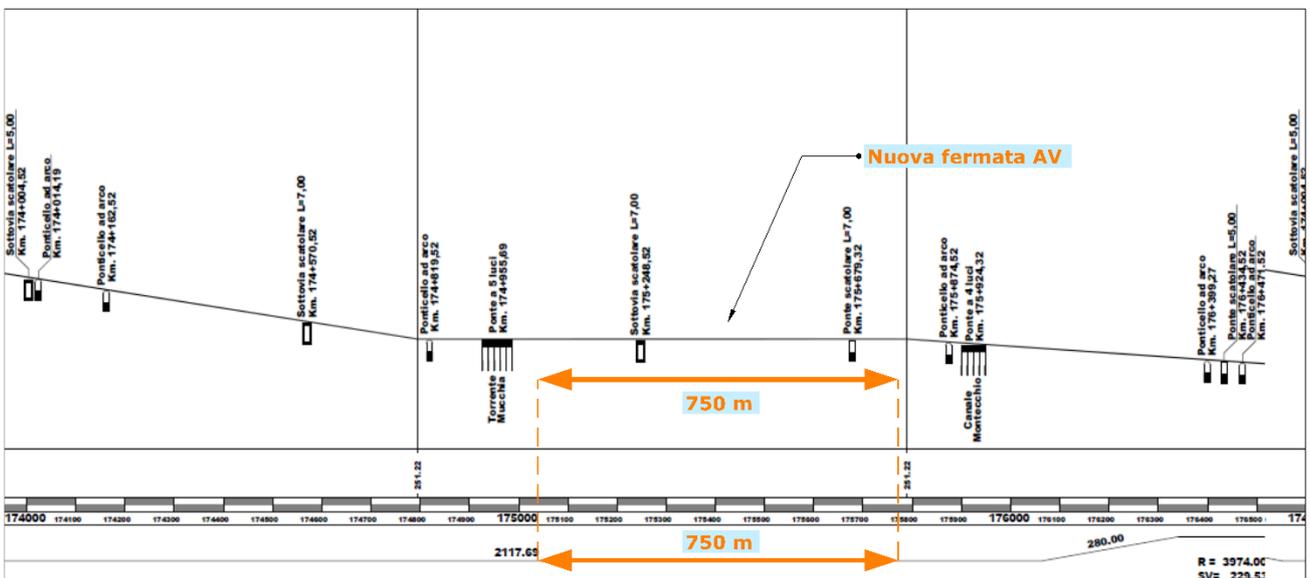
C. Altimetria e andamento della tratta Bettolle Creti
